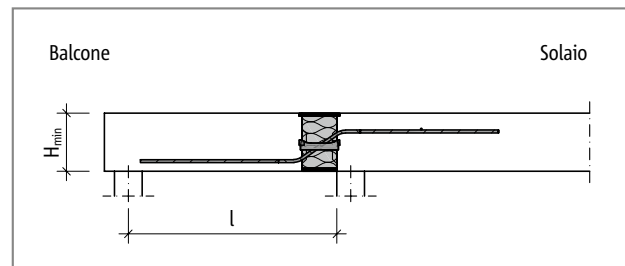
Schöck Isokorb® XT tipo QL: schema statico (XT tipo QL-V5 - V8)
